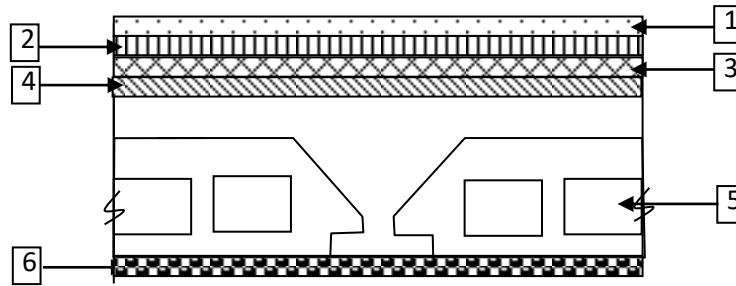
Coupe transversale d'un plancher terrasse accessible
